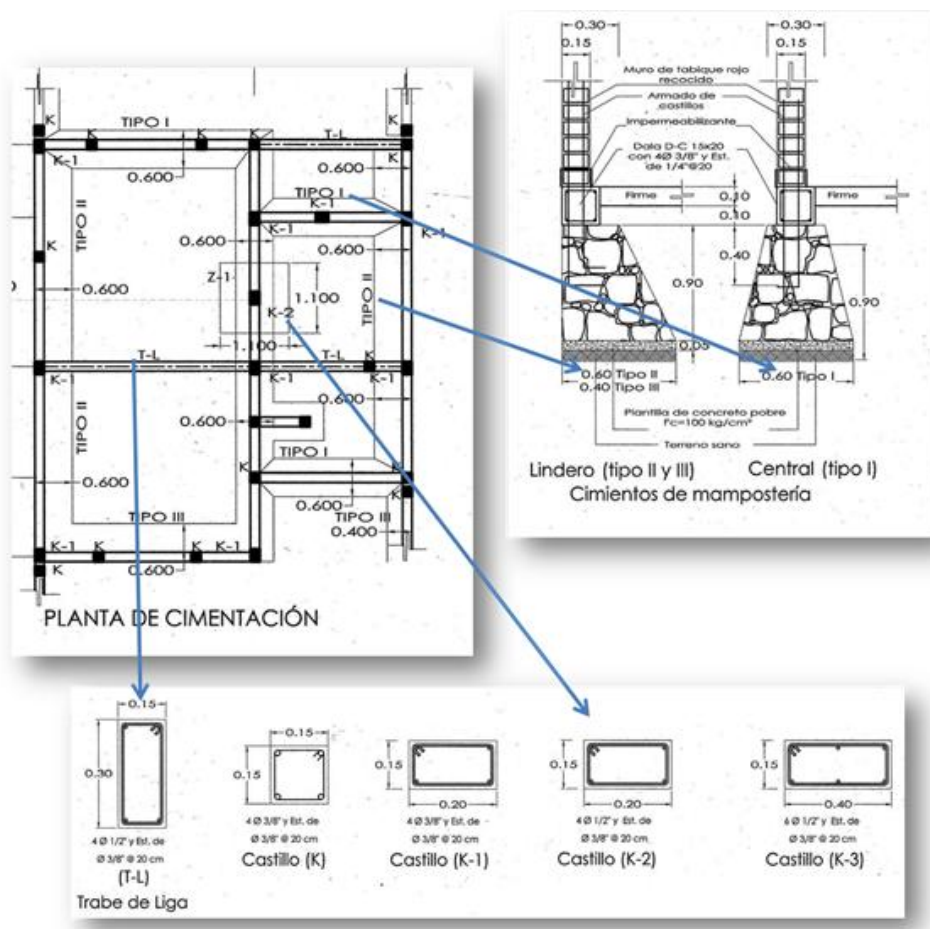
Representación en planta y alzado de zapata y castillos
